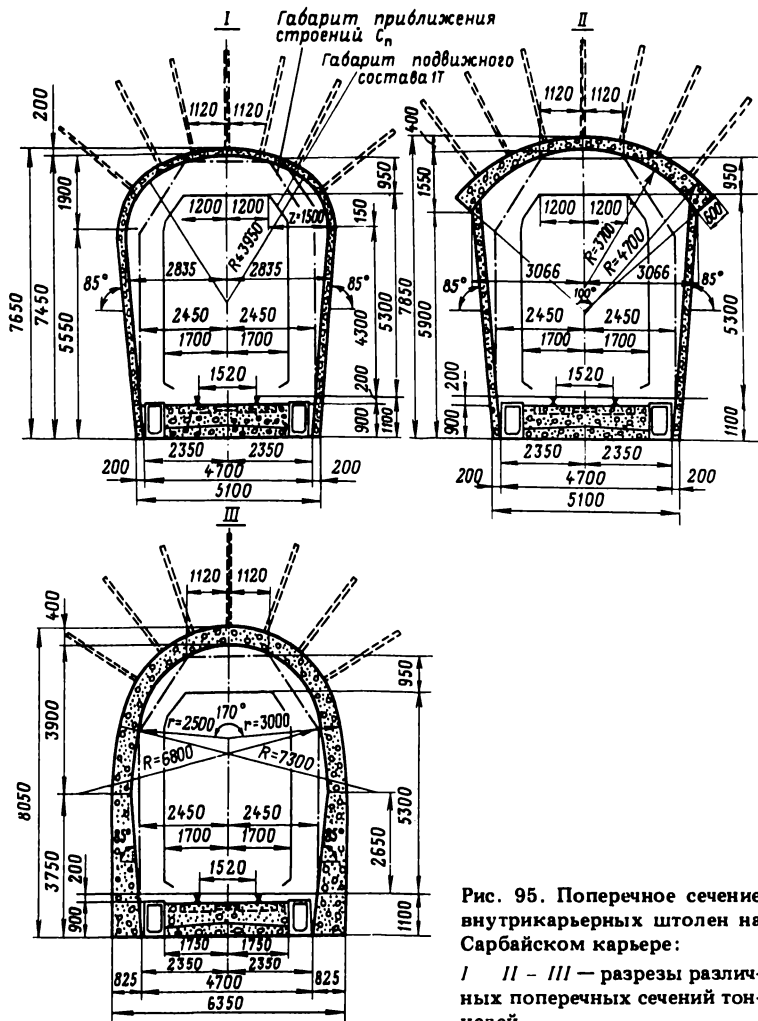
Поперечное сечение внутрикарьерных штолен на Сарбайском карьере:
